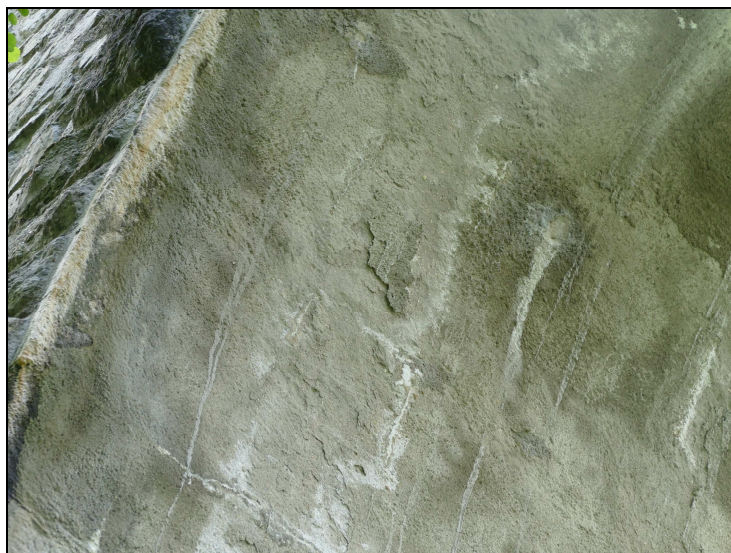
Konstrukce K 04 – z podhledu– výluhy pojiva, odloupaná omítka, vzdutá (foto 2019)
